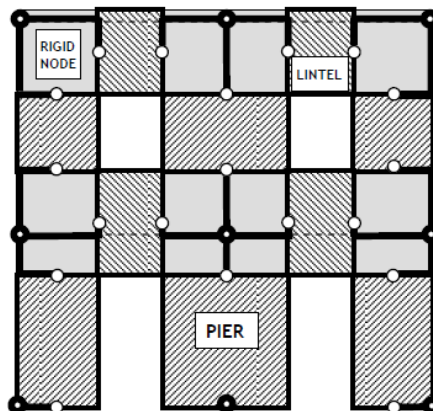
Suddivisione in macroelementi di una parete muraria
